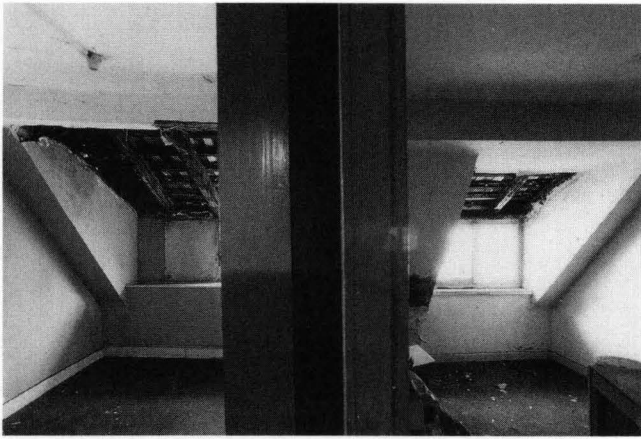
Blick in die beiden strassenseitigen Mansarden von Haus 2 Nord, deren Dachausbauten als ehemals offene Gerbergaupe anzusehen sind. 1989 abgebrochen bzw. durch neuen Dachausbau ersetzt. – Foto: BaDpf. B 379/32.
